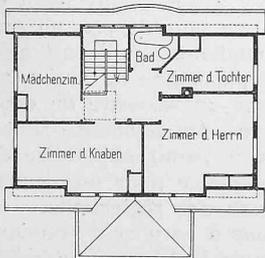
Grundriss vom Obergeschoss des Sommerhauses «Rotenus». — 1:400.
